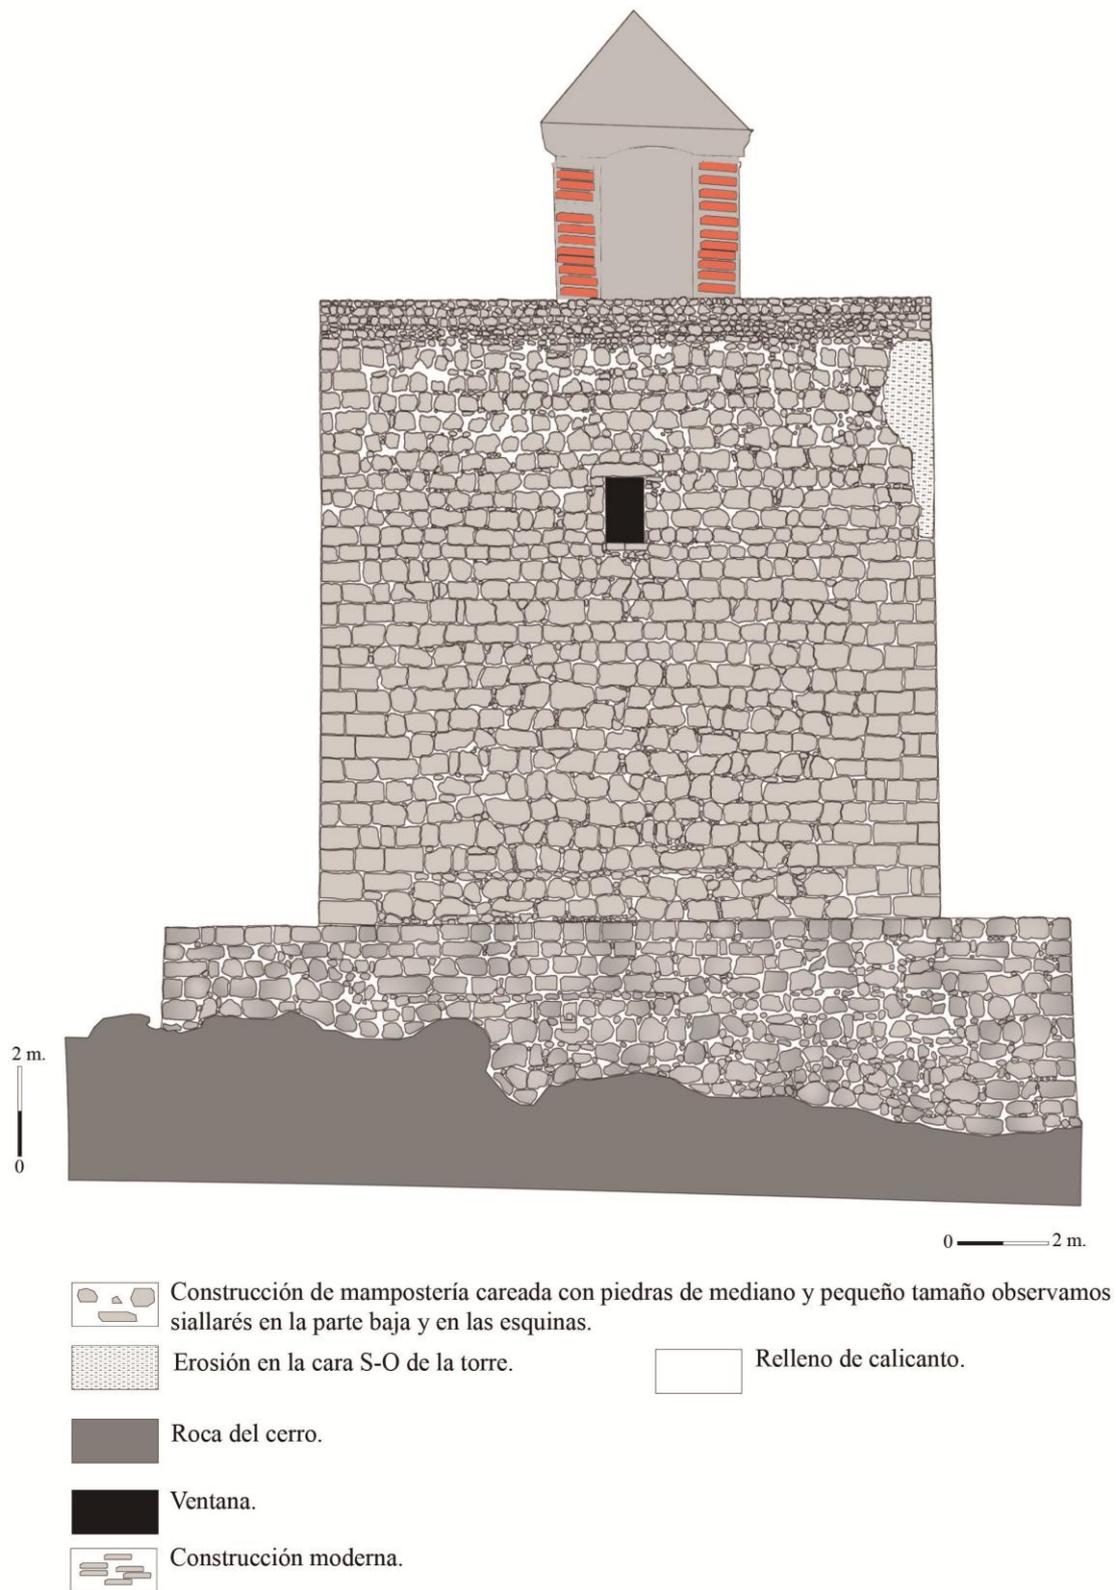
Torre del Homenaje (T_1) en su cara exterior suroeste. Técnica constructiva: Sillería en la parte baja y mampostería de piedras de mediano y pequeño tamaño, en el resto. (Elaboración propia).
